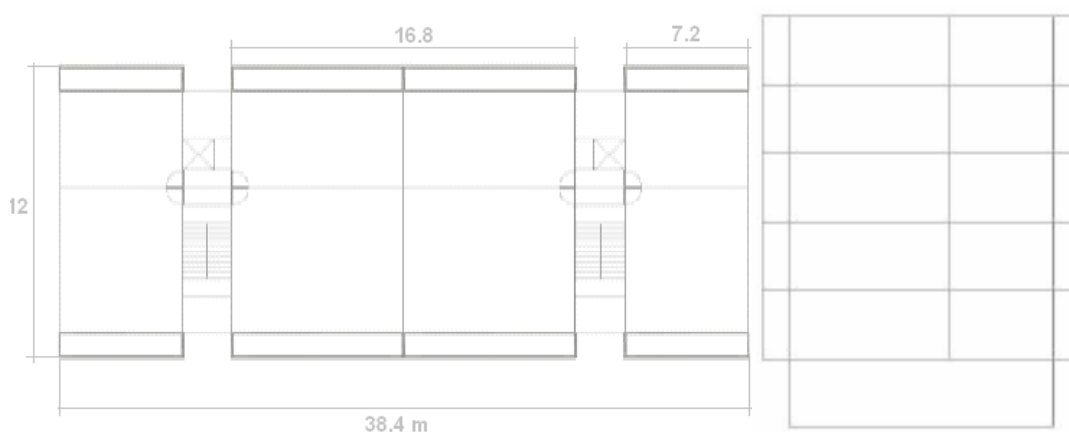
Distribución en planta (izda.) y alzado (dcha.) del edificio tipo
